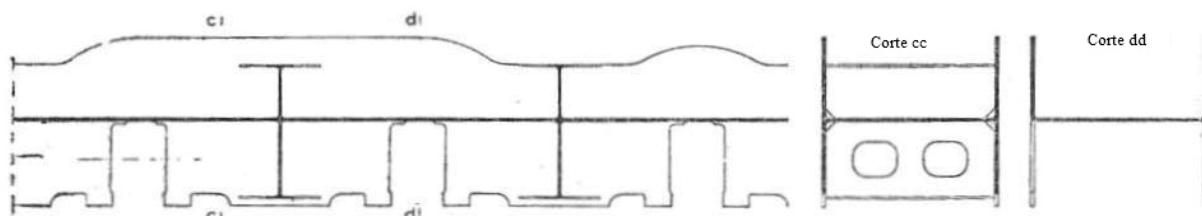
Largueros de planchas, soldados con autógena, disposición en H.
